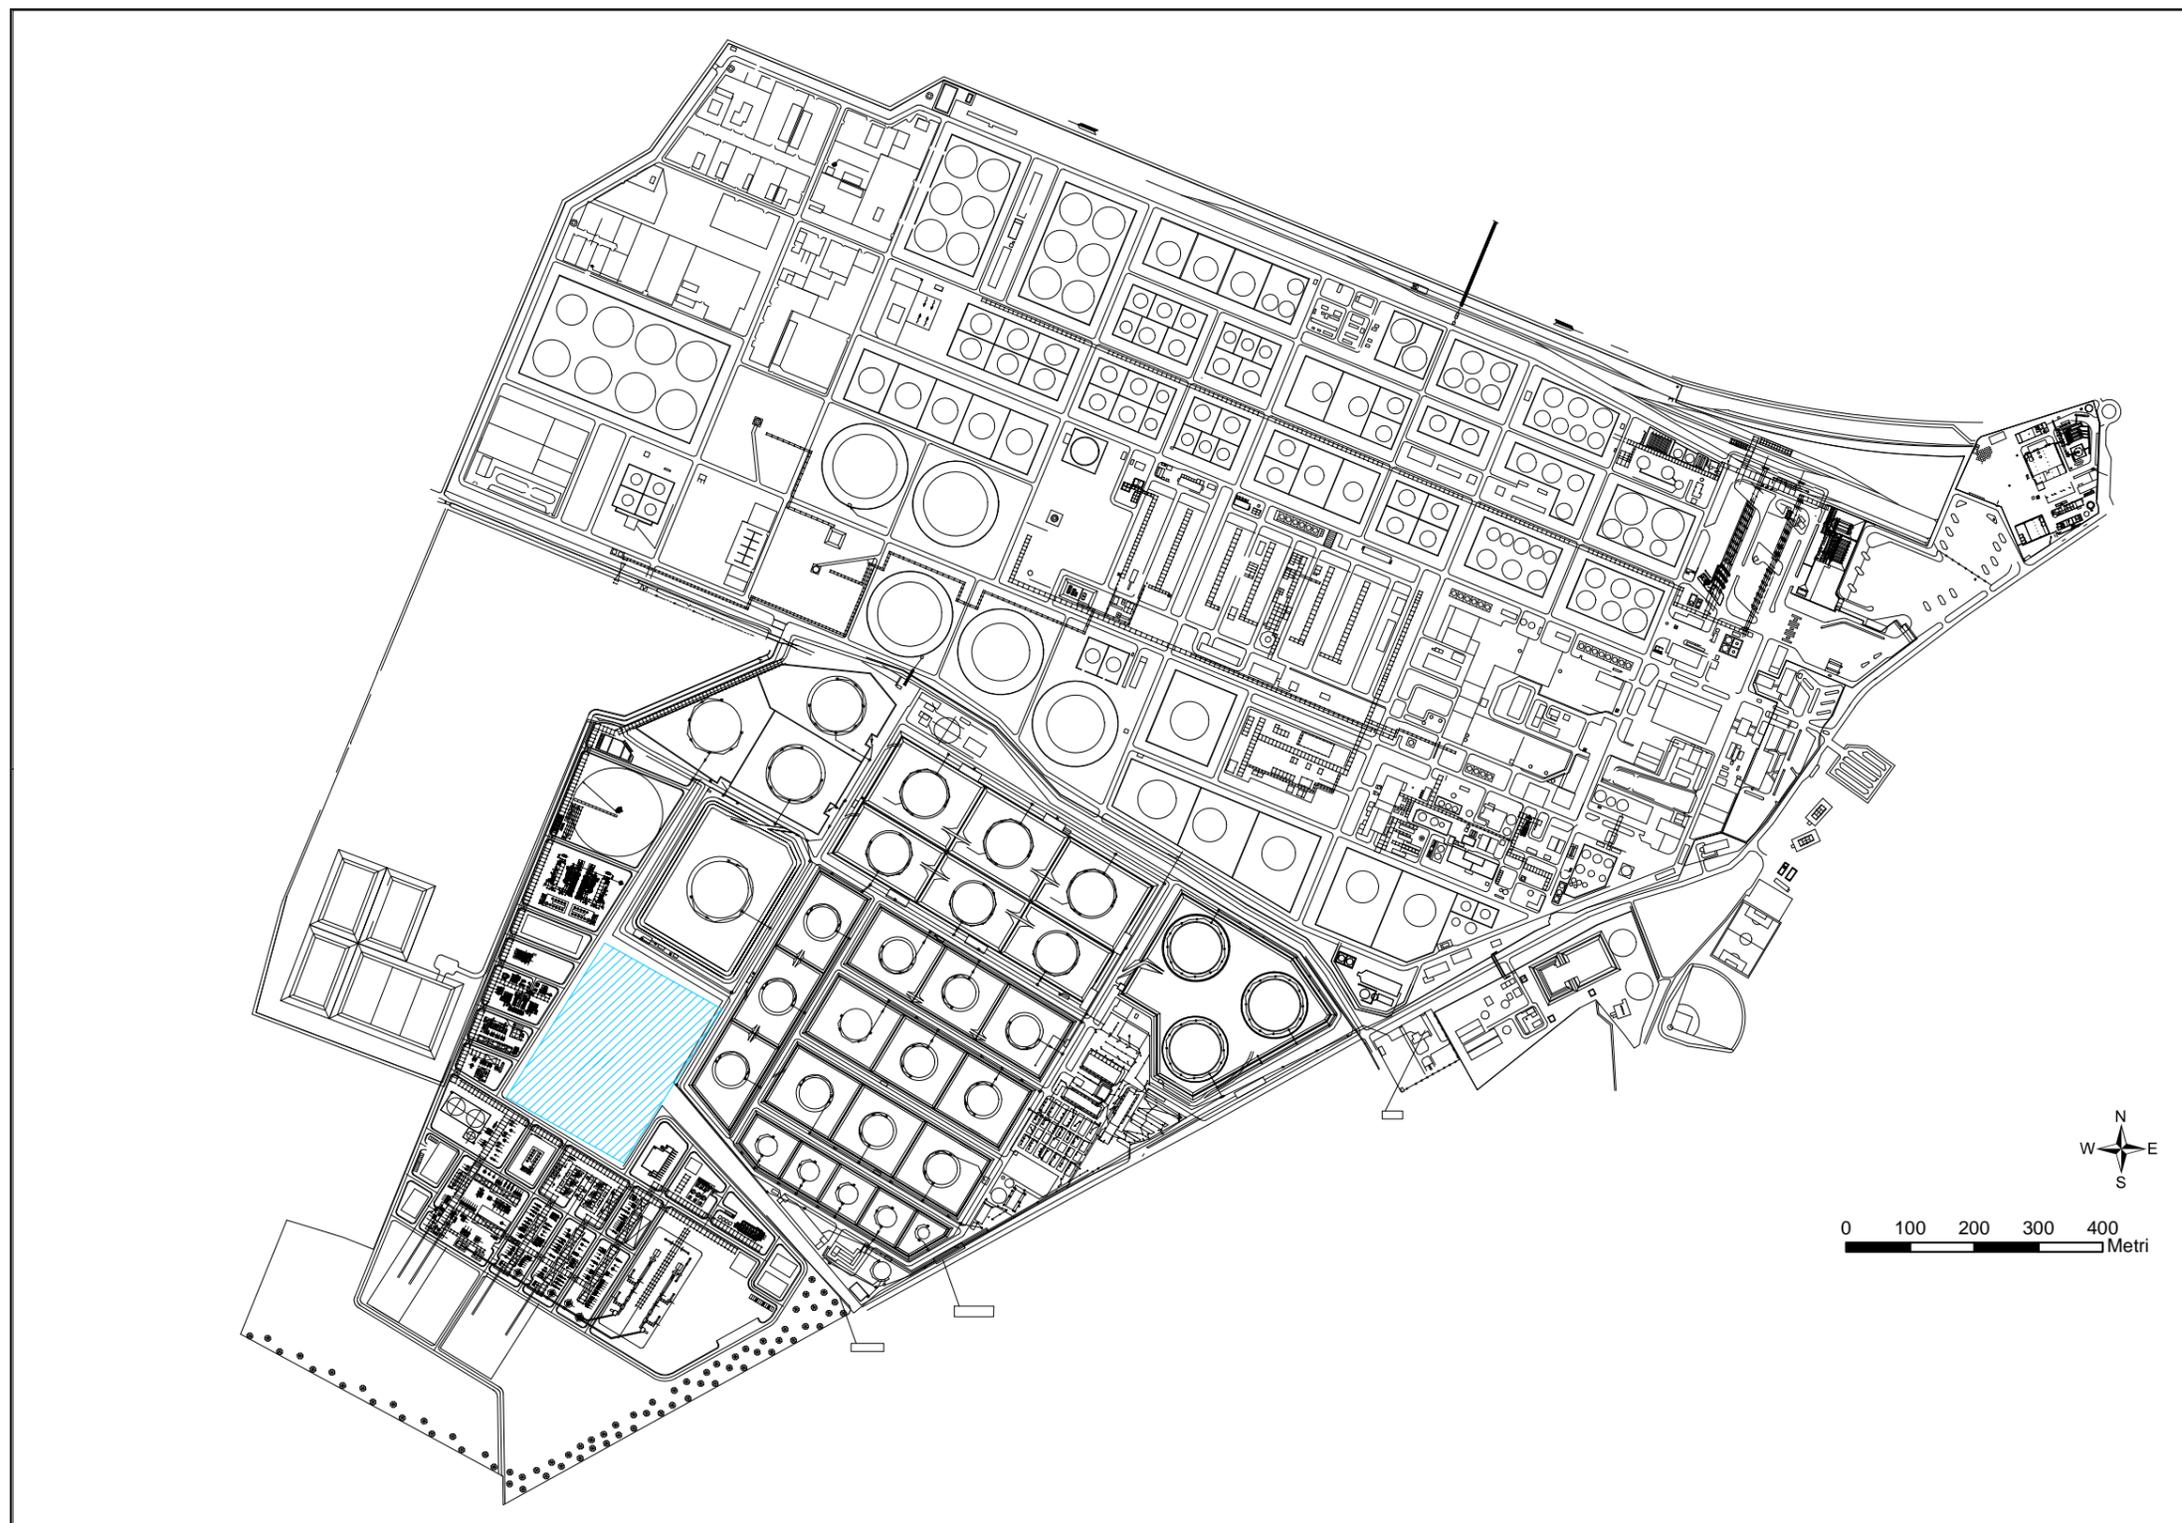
B: Planimetria Generale di Raffineria – STATO POST OPERAM
